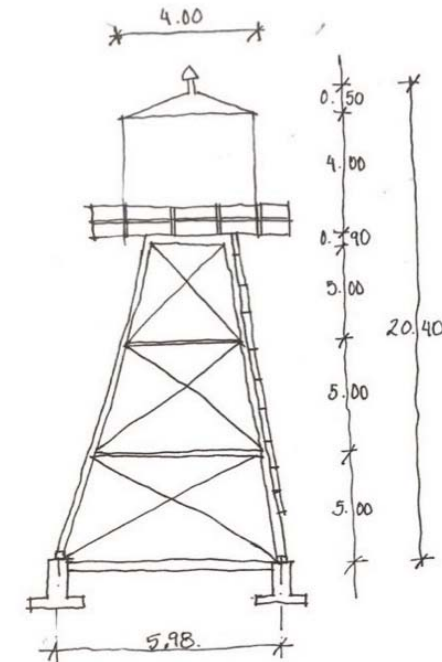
Tanque elevado. Alzado. Croquis personal
